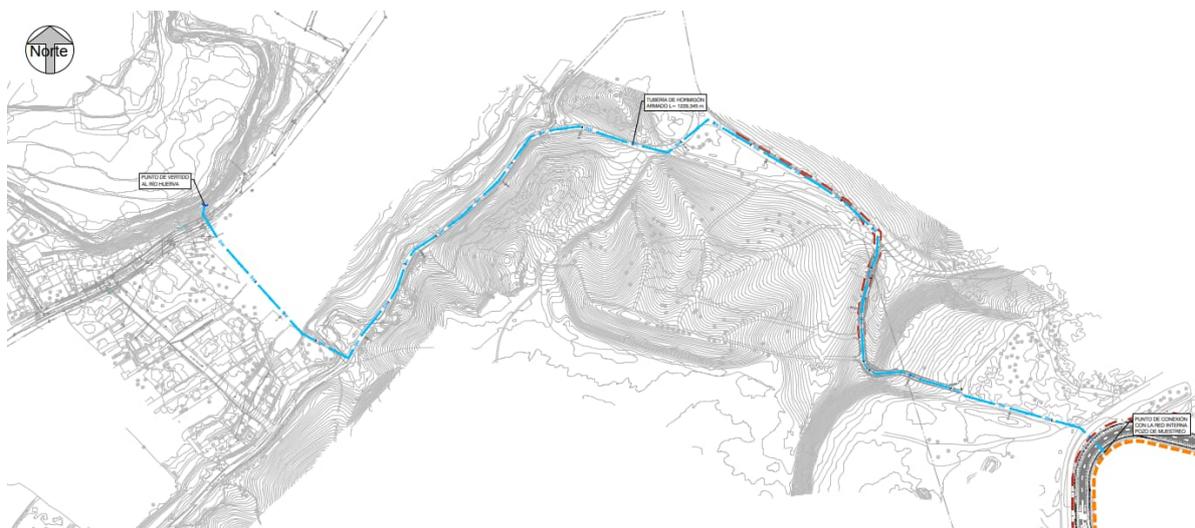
Detalle Alternativa 3. Fuente: AECOM, 2025.
